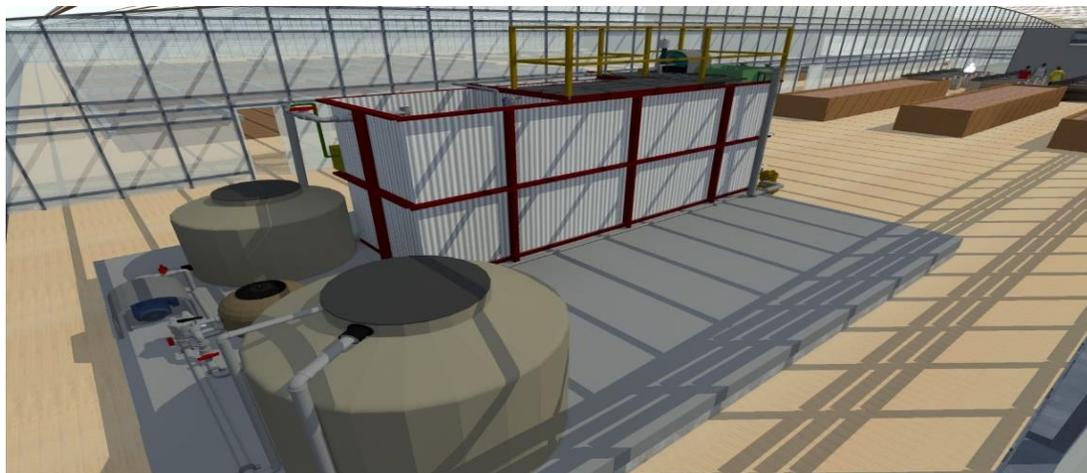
Planta de riego para suministro de agua. Elaboración propia.
